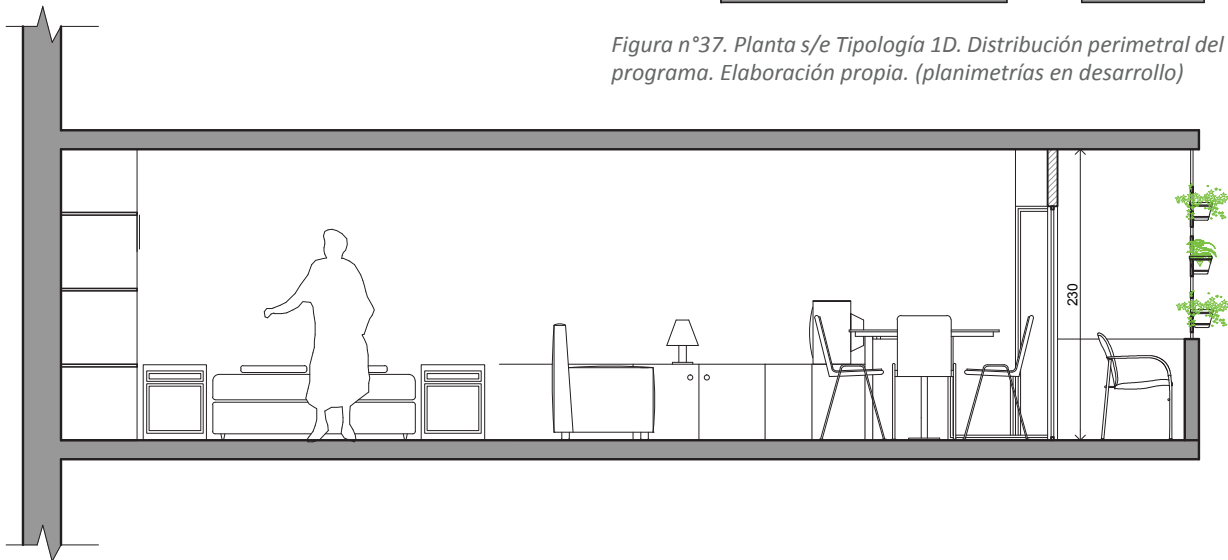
Corte s/e Tipología 1D. Elaboración propia. (planimetrías en desarrollo)
